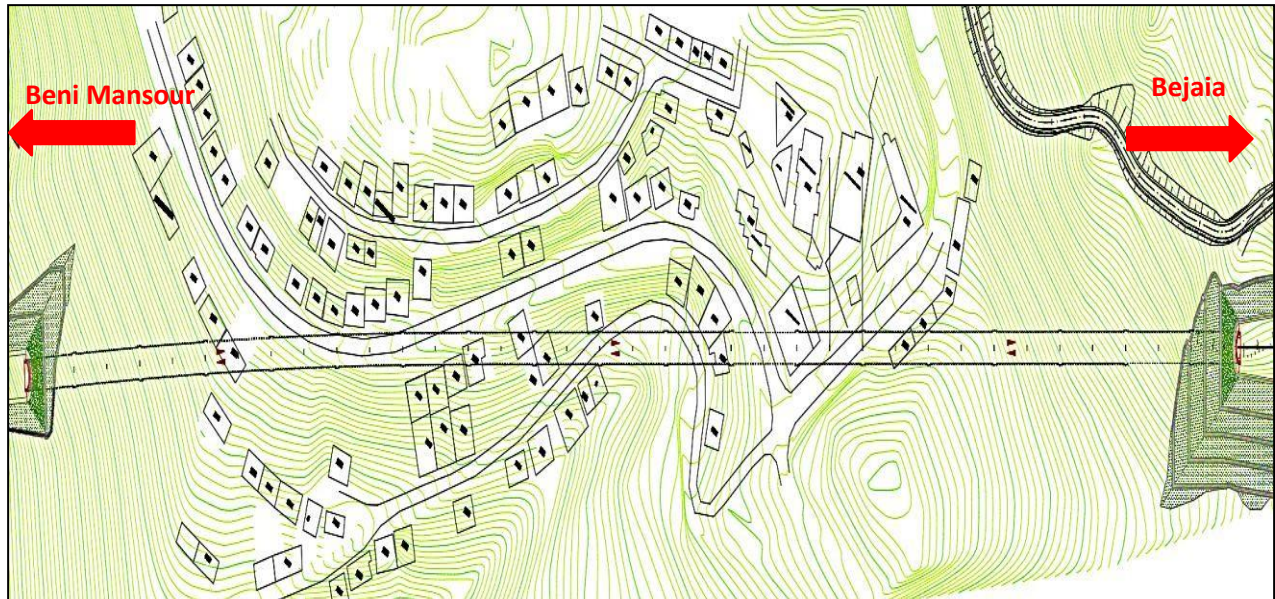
Vue en plan du tracé du tunnel SIDI AICH.
